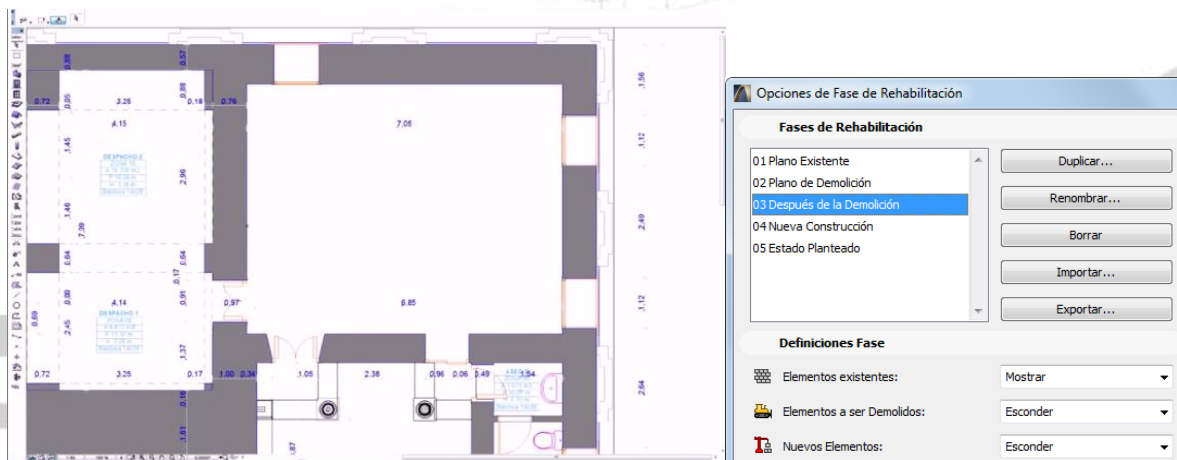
Fase Tras la Demolición: es igual que el filtro Plan de Demolición, excepto por el hecho de que los elementos “A ser demolidos” desaparecen. Solo aparecen los elementos existentes.
